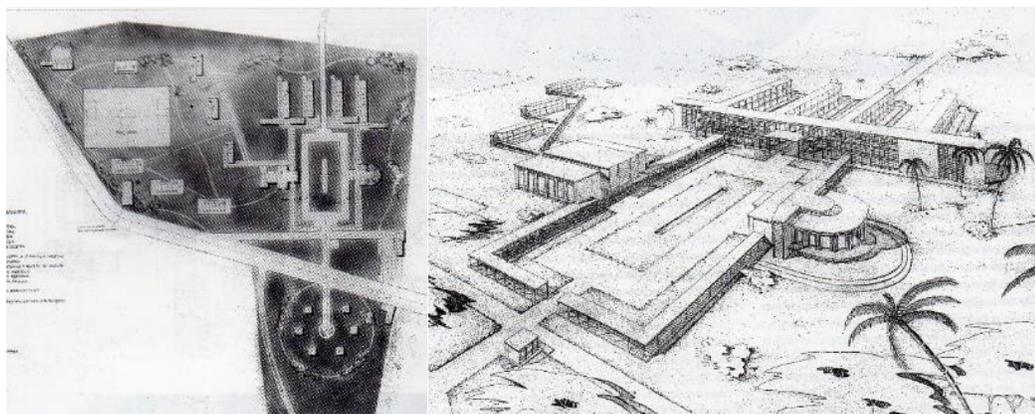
Planta e Isometría Facultad de Agronomía Palmira. Fuente Arquitectura y Estado. Pag 277
